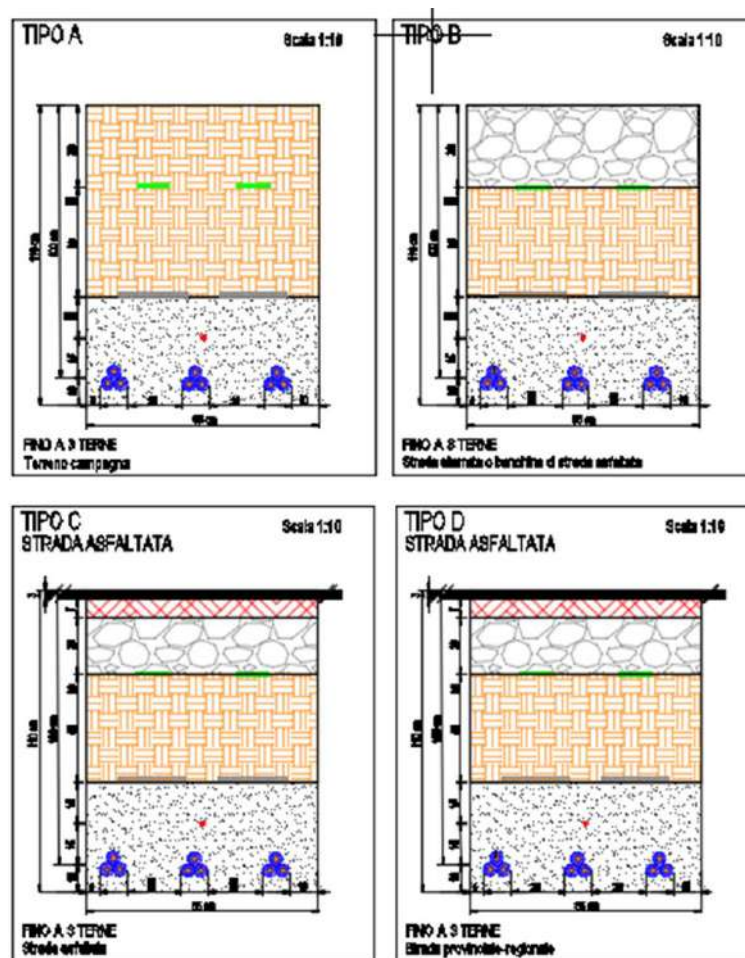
Sezione tipica di posa della linea in cavo su sede stradale per triplo cavidotto in MT
